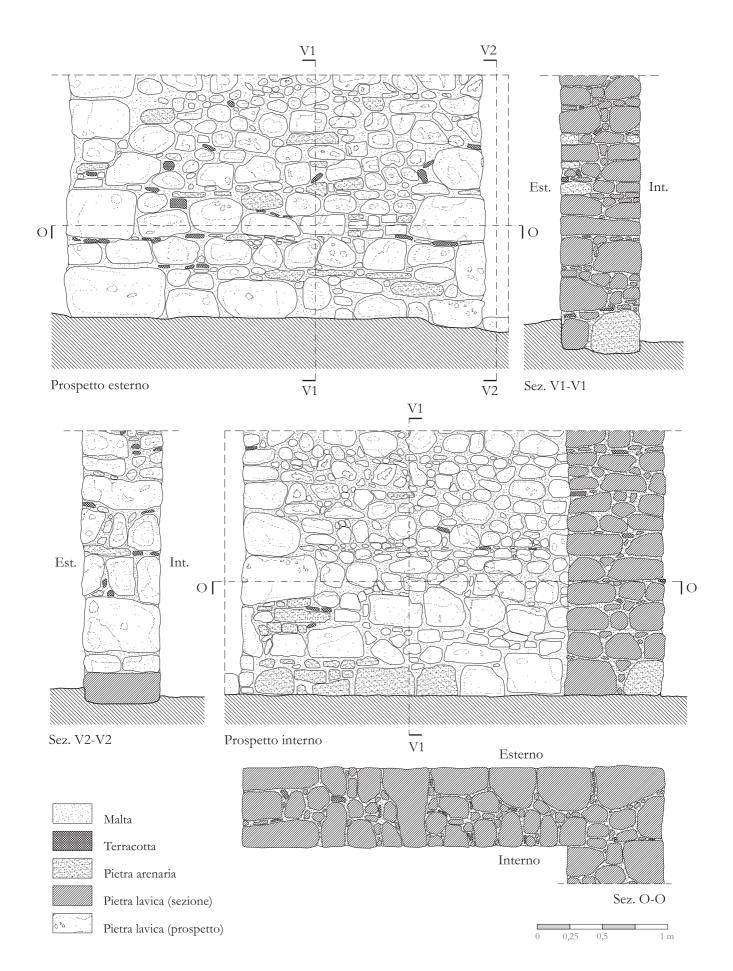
Dettaglio dell'apparecchiatura muraria in prospetto e sezione.
